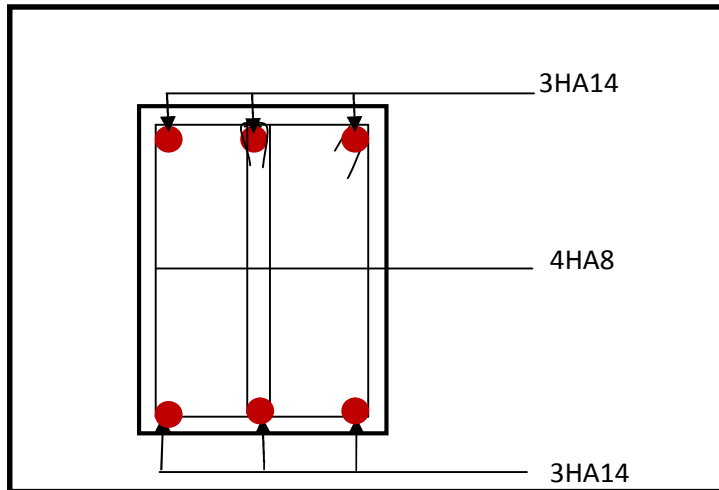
Figure.VI: Ferrailage en travée d'une poutre secondaire :
